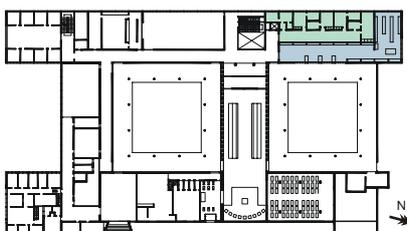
Biblioteca (em azul) e Enfermaria (em verde). Primeiro Pavimento. Obra construída. Note-se a ausência das salas de arquivo neste pavimento, que foram remanejadas para o subsolo deste mesmo bloco. (Desenho da autora).
